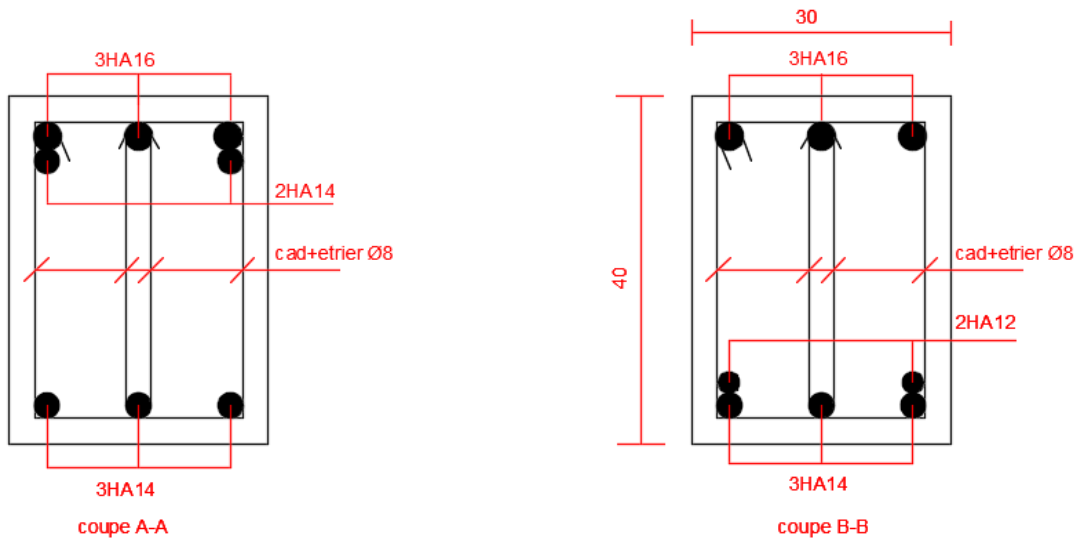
schéma de ferrailage de poutre principale étage 4
